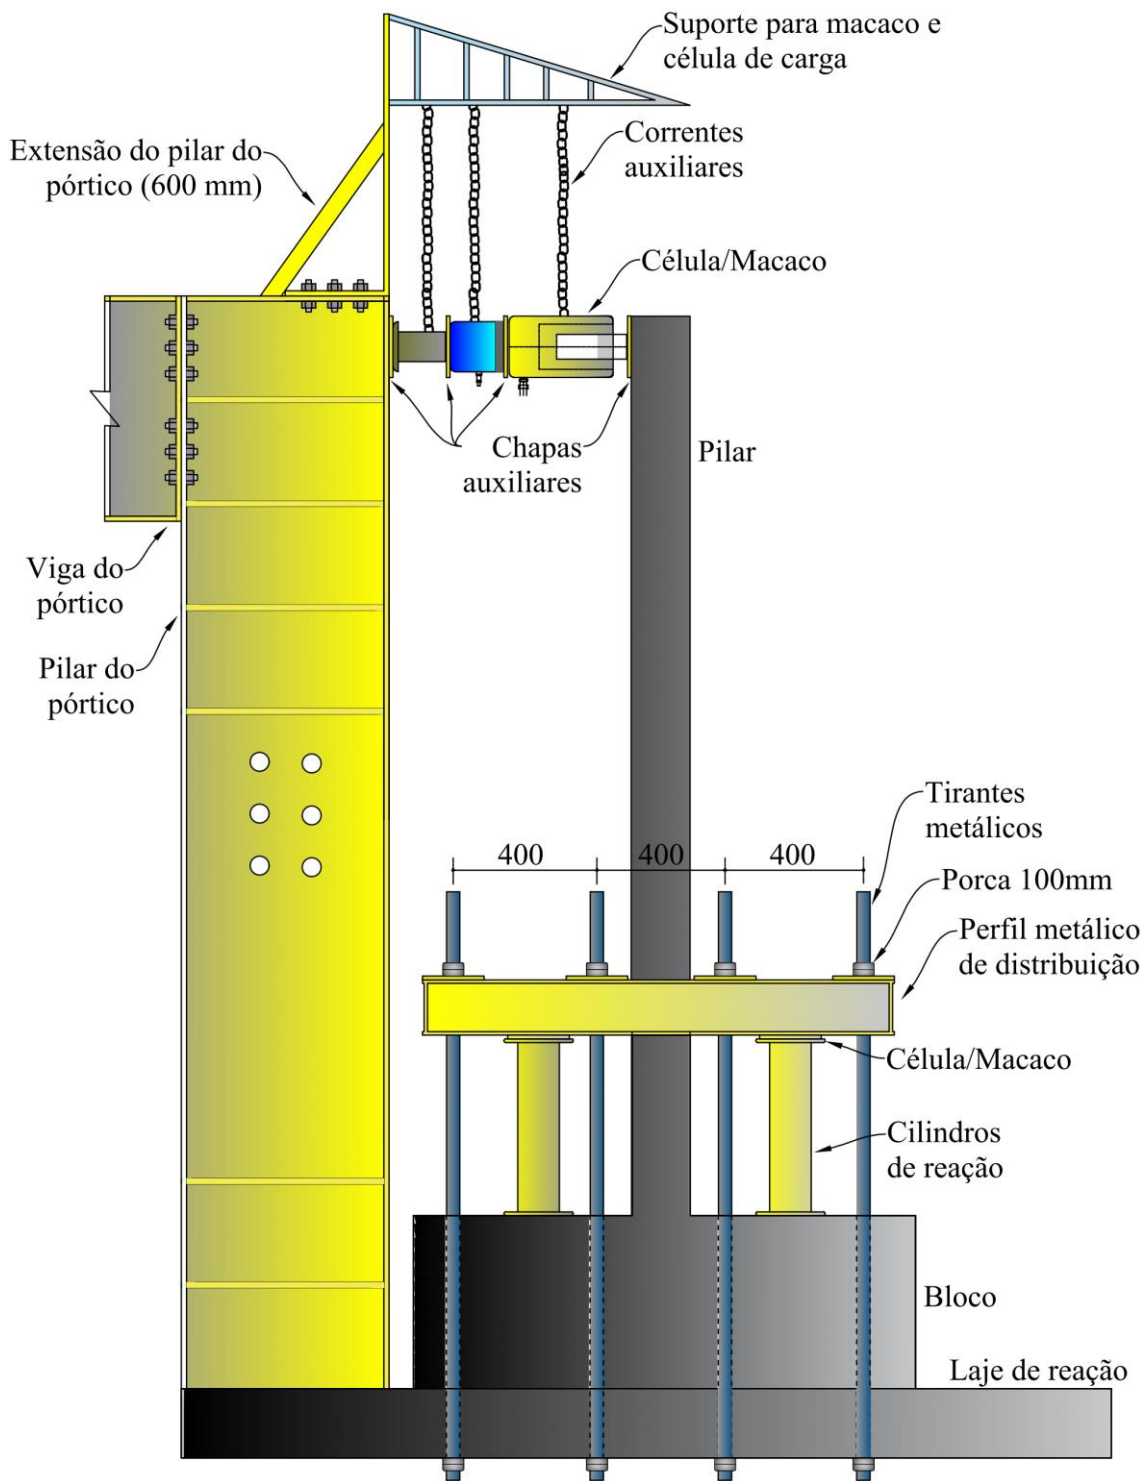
Sistema de ensaio do pilar P3 (Fonte: Autor)
